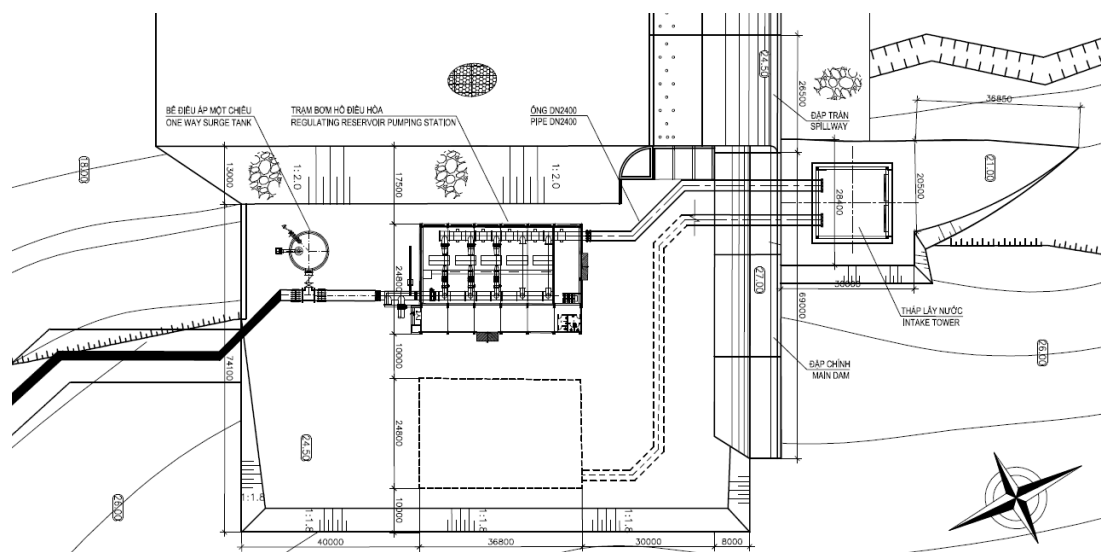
一方向サージタンクを併設した調整池ポンプ場の平面図
